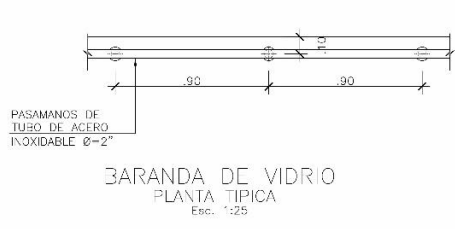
Plano de Detalles Arquitectónicos (Barandas Exteriores) - Elaboración propia
